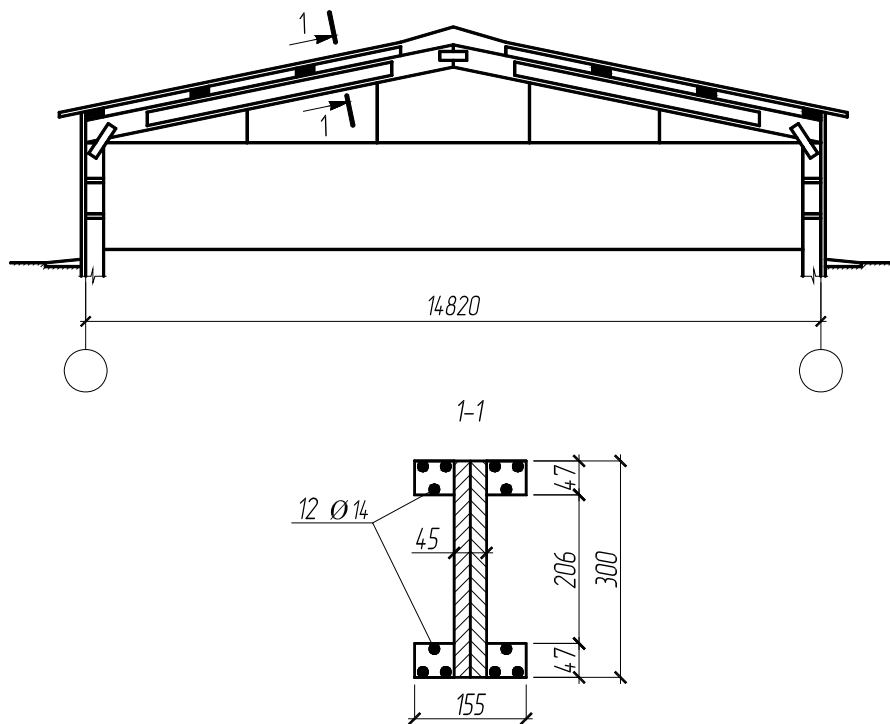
Клееная армированная треугольная арка в покрытии производственного здания (Швеция)
